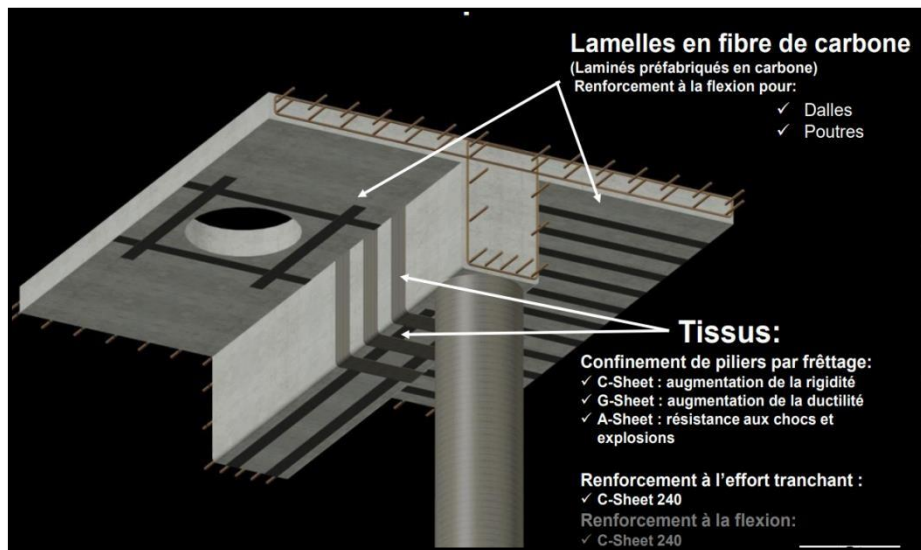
Lamelles en fibre de carbone renforcement poutres et dalles.
